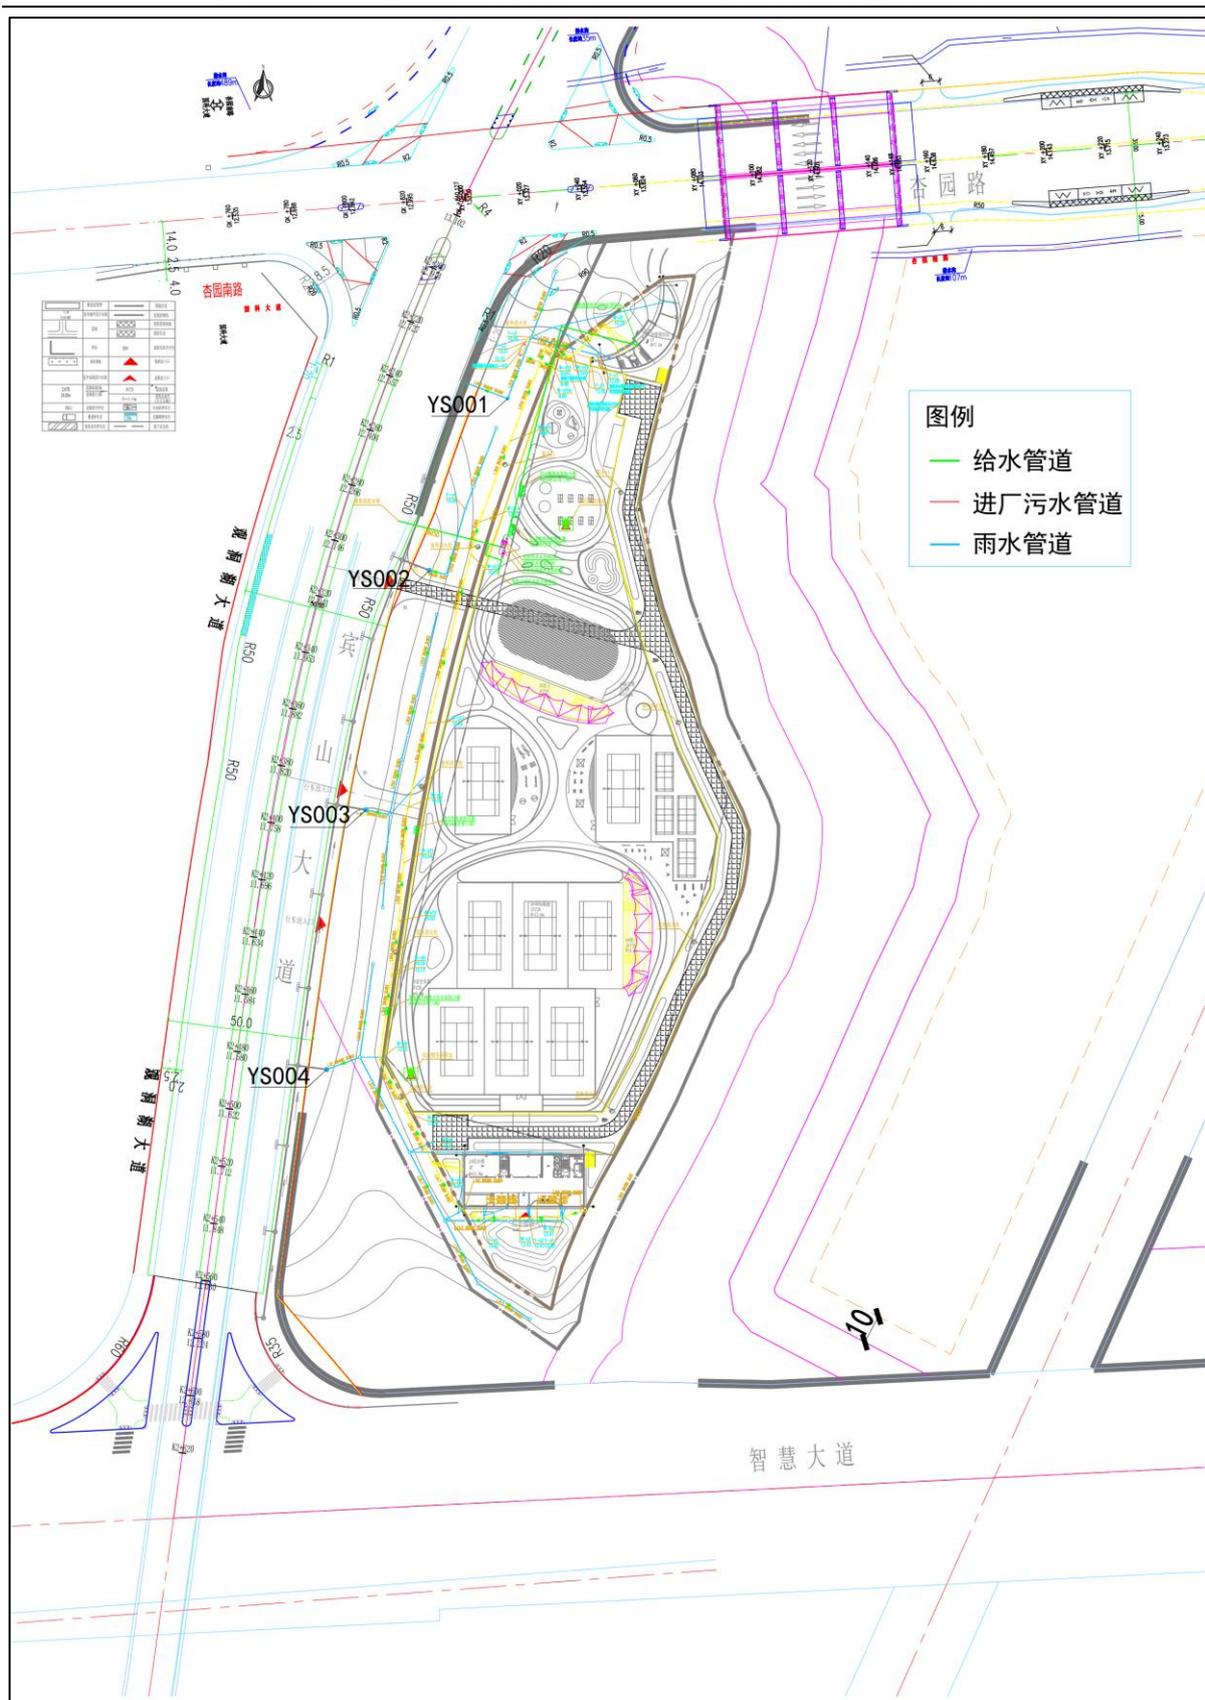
项目给水、进厂污水、雨水管道平面布置图
